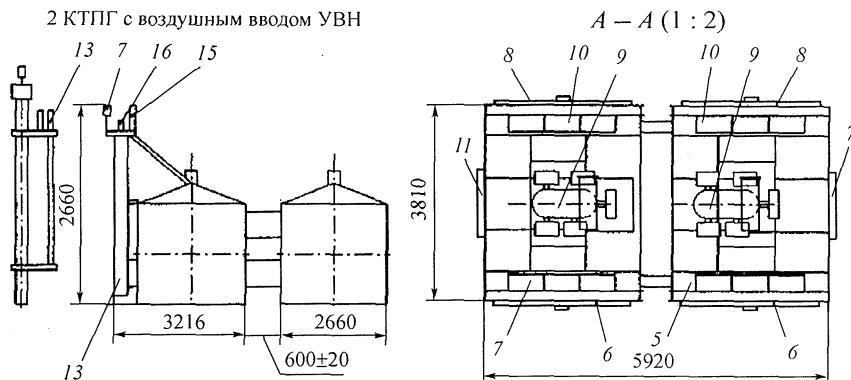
Общий вид, габаритные и установочные размеры однотрансформаторной КТПГ:
